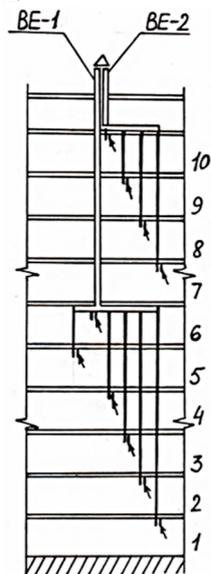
Схема системы вытяжной вентиляции многоквартирного жилого дома
